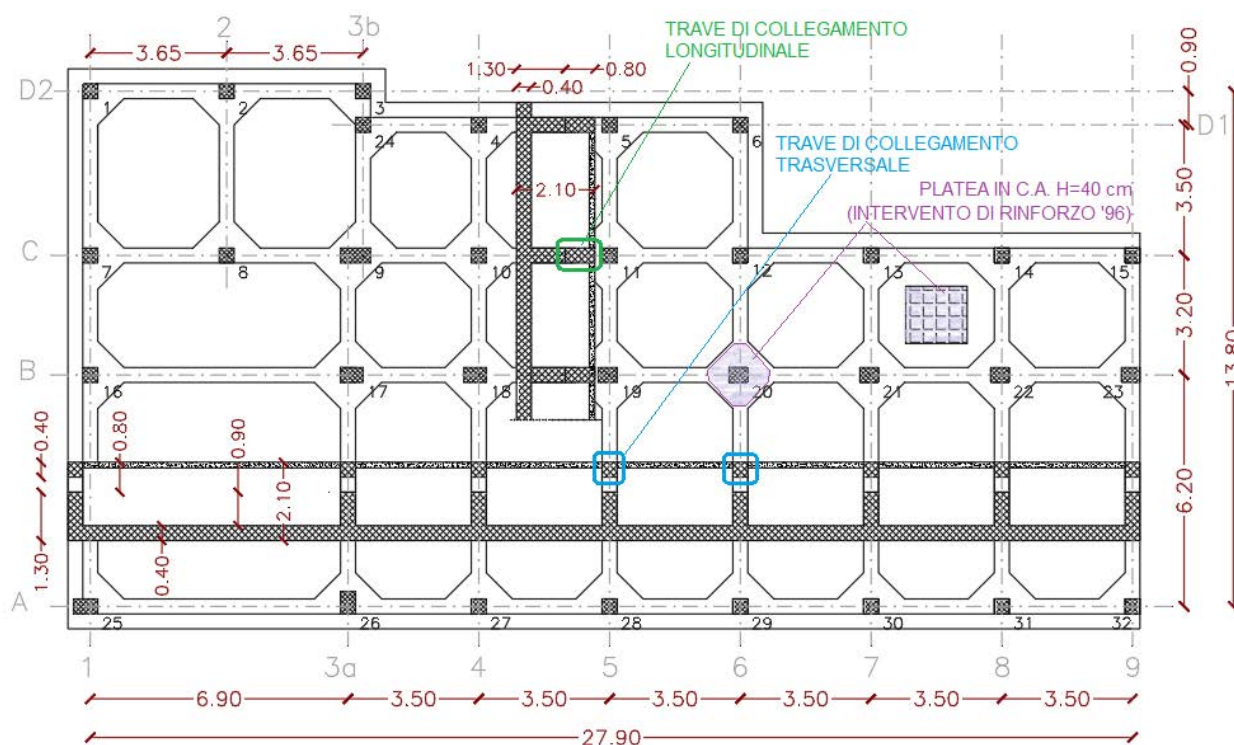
STATO DI FATTO: STRALCIO DELLA PIANTA DI FONDAZIONE DEL BLOCCO A
